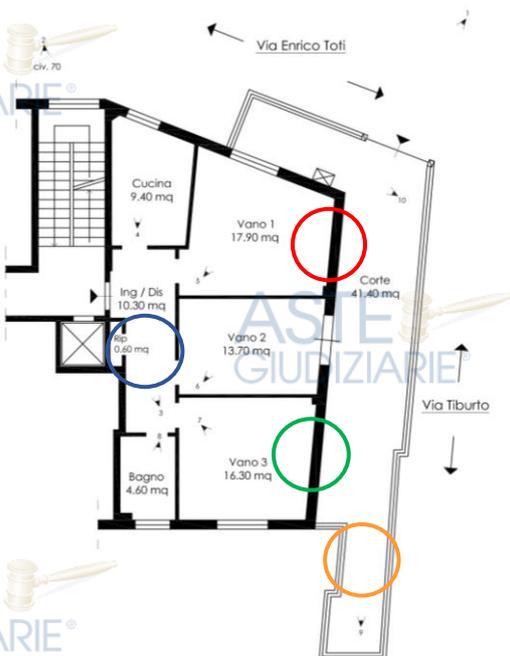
Pianta piano tipo Licenza Edilizia 59/1972.
